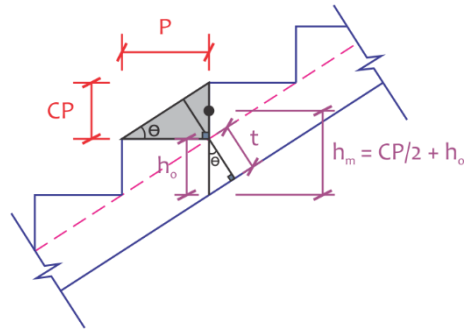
Ancho Efectivo de la Losa de la Escalera.
